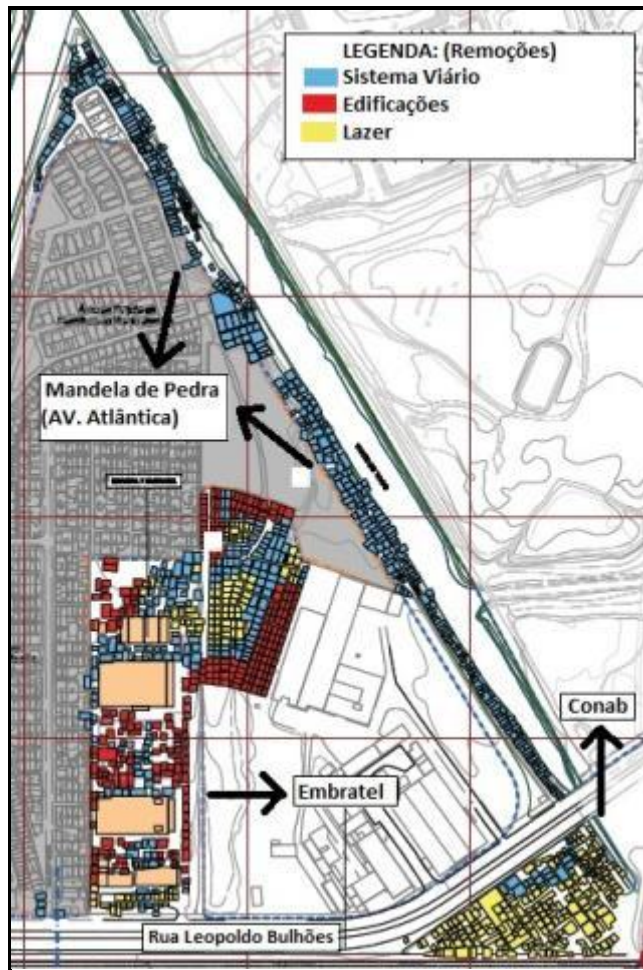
Indicações de remoções e moradias da Embratel, Mandela de Pedra e Conab elaboradas sobre fragmento de planta de remoções. 2007. Fonte: Licitação de Obras, Planta man-pb-re-01.pdf
